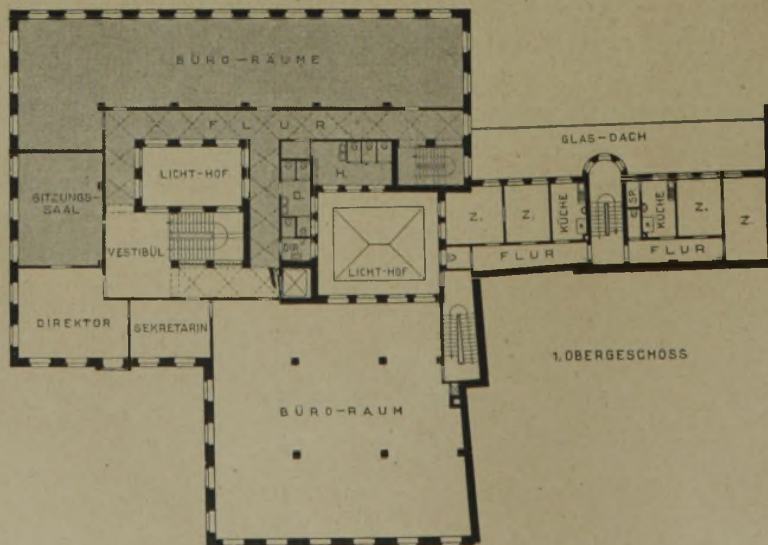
(oben). Erdgeschoß-Grundriß. Abb. 4 (unten). I. Obergeschoß. (1 : 500.)
